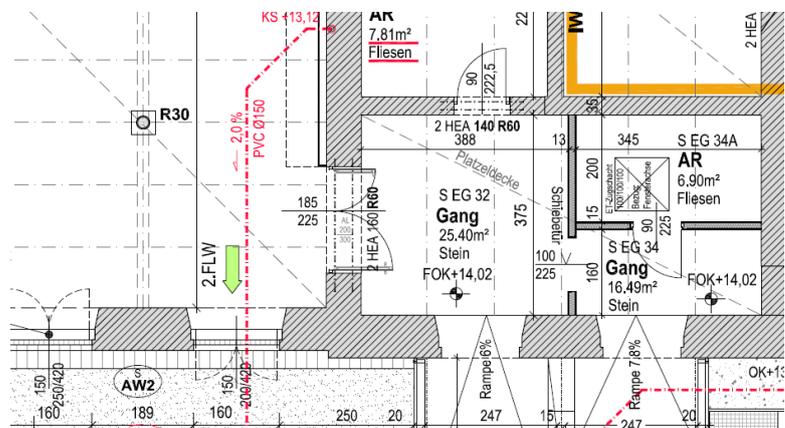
Planausschnitt Bestandsplan SEG23_3
